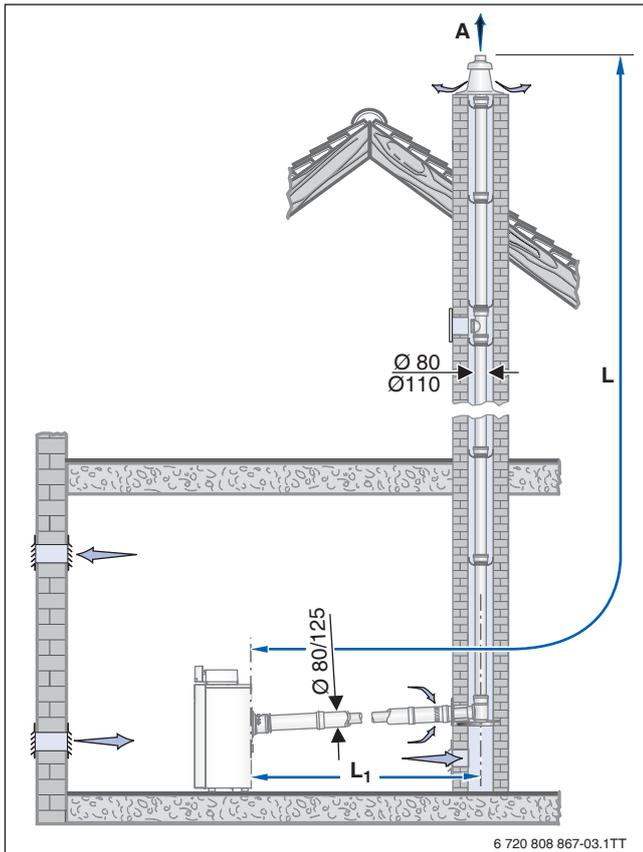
Montagevariante mit dem Bausatz GA-X + GA-K
